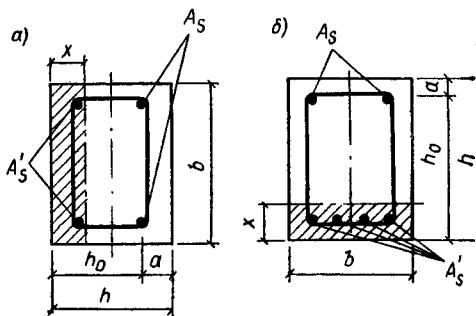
К расчету элементов прямоугольного сечения, работающих на изгиб с кручением
